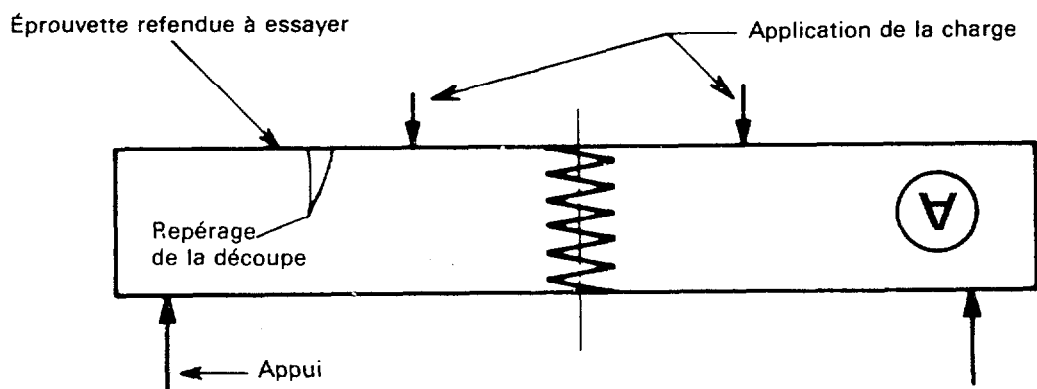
Position de l'éprouvette dans la machine d'essai
